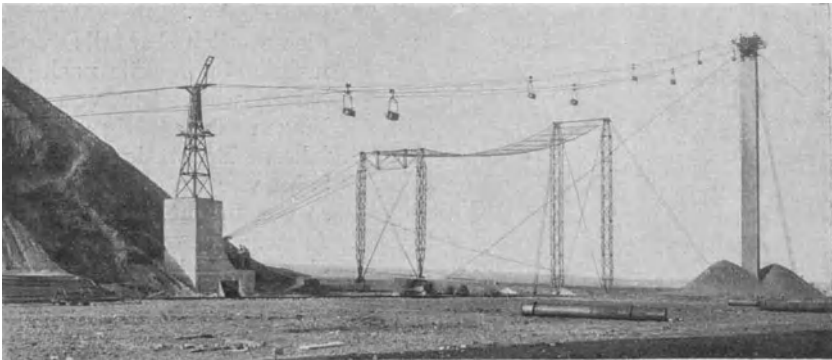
Eiserne Turmstation mit Umbetonierung.
